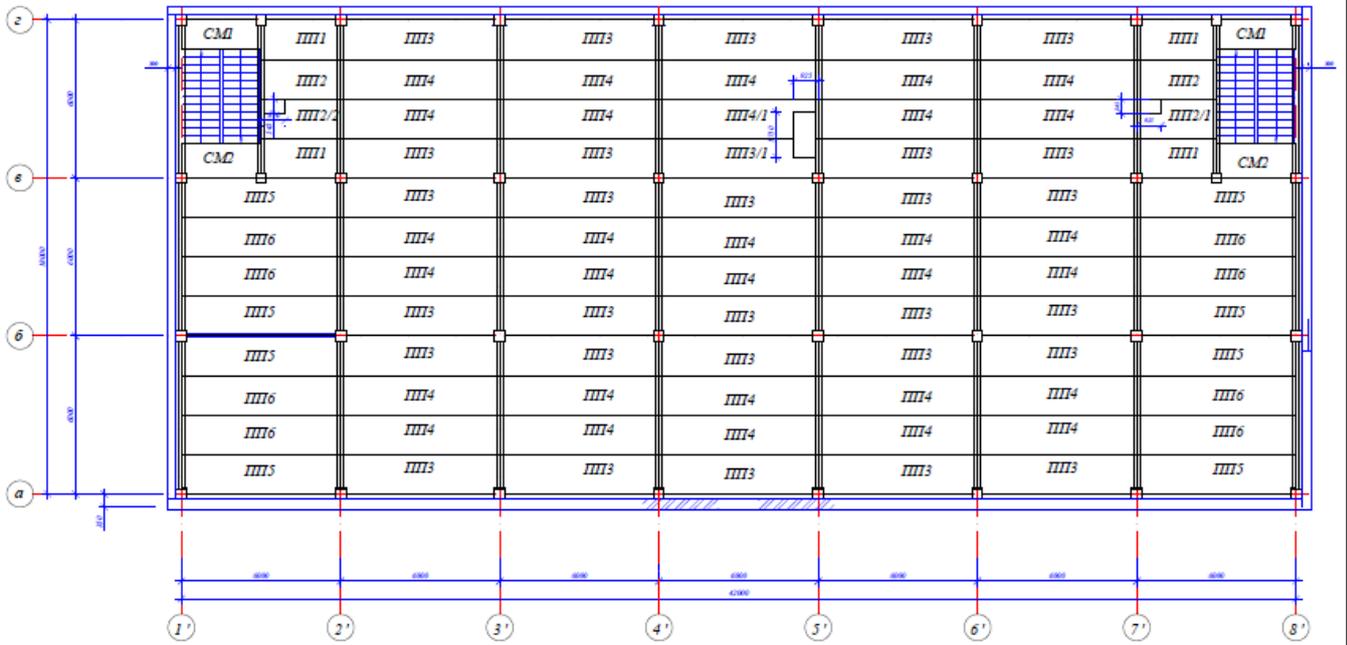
Схема розміщення плит перекриття на відм.+3,300
